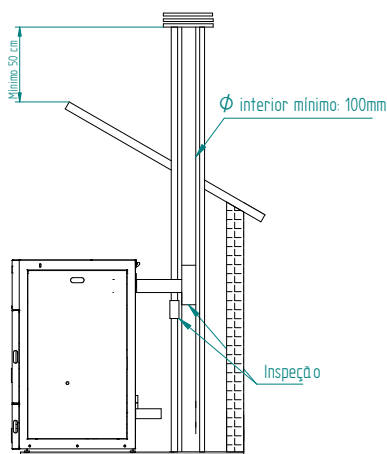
Vista lateral da instalação com chaminé, com exemplo do ponto de inspeção.
